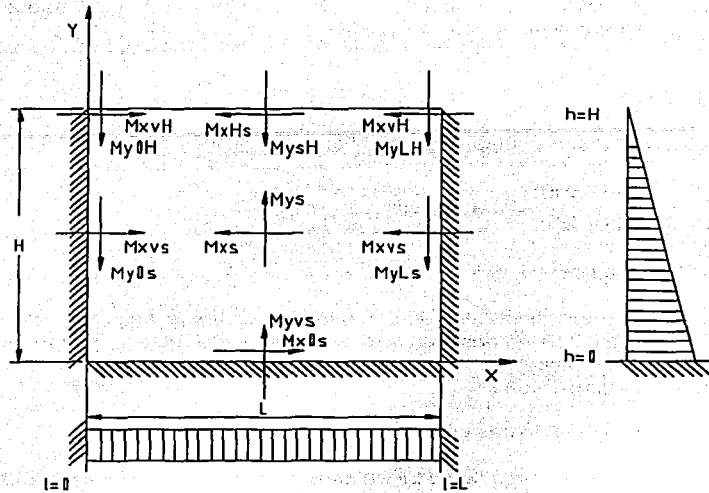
Muro empotrado en su base y laterales, libre en el borde superior ⁽¹⁵⁾
